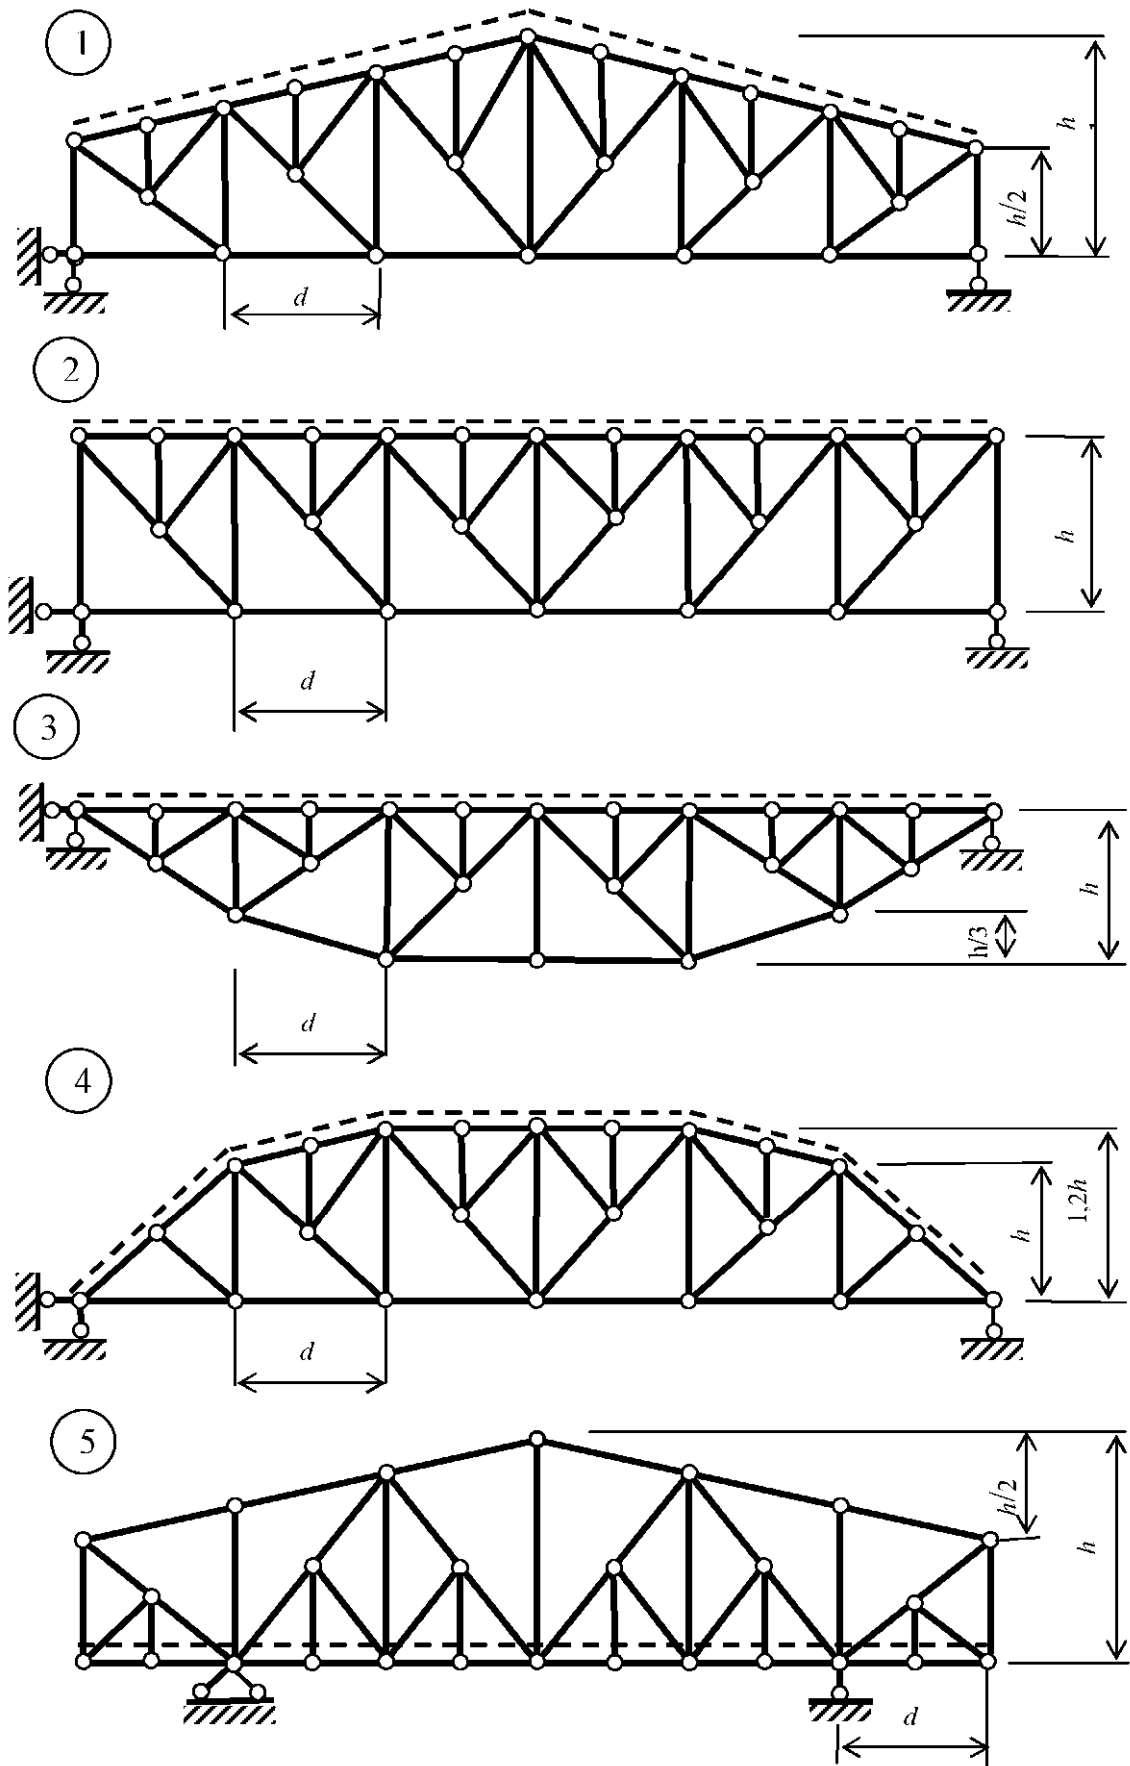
Расчетные схемы 1-5 шпренгельных ферм
